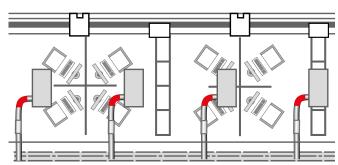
Installationsbeispiel. Gerader Luftanschluss bzw. mit 90
